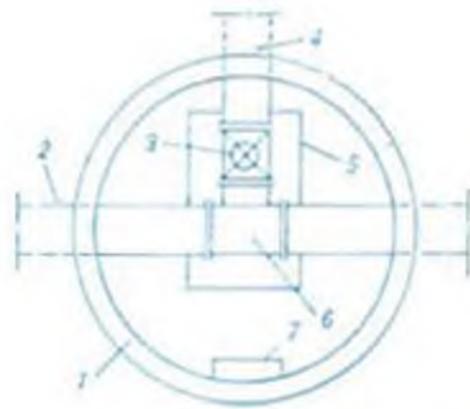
Сбросной колодец (вид сверху со снятой крышкой): 1 — стенки колодца; 2 — напорный трубопровод; 3 — задвижка; 4 — сбросная труба; 5 — бетонная подушка; 6 — тройник; 7 — ходовая скоба.
